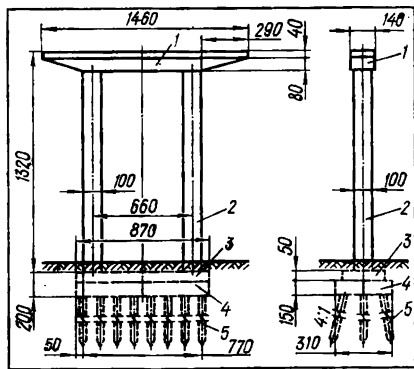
Промежуточная опора на свайном фундаменте из оболочек диаметром 0,8—1,2 м:
